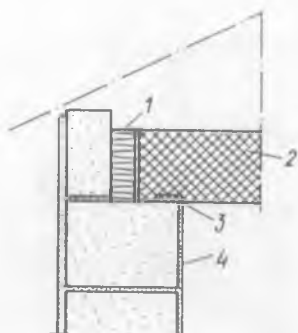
Опираие плиты перекрытия вдоль отверстия в стене
